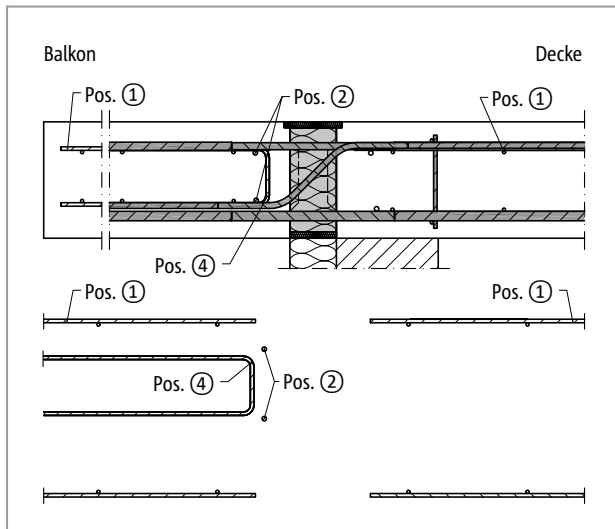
Schöck Isokorb® T Typ K-M13 bis M14: Bauseitige Bewehrung bei direkter Lagerung
